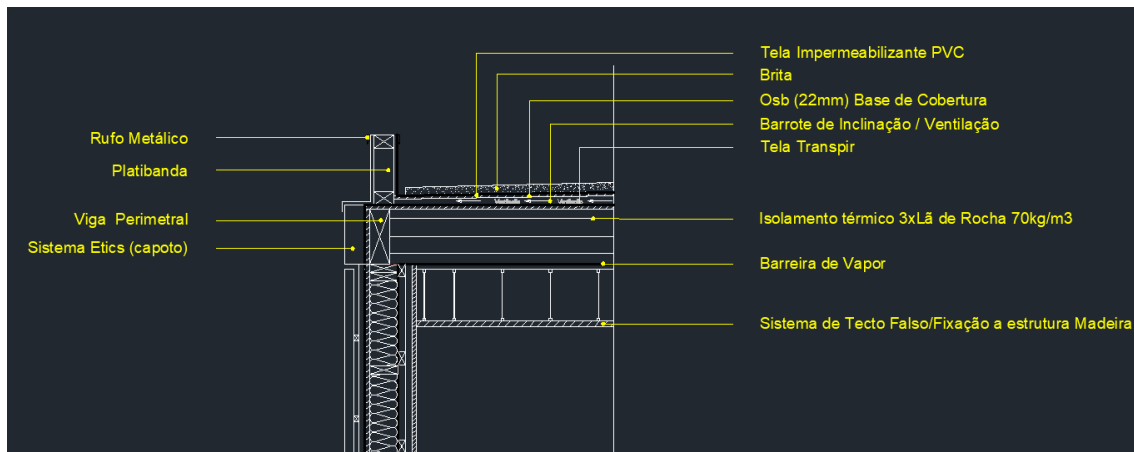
Pormenor da ligação entre a parede e a cobertura
